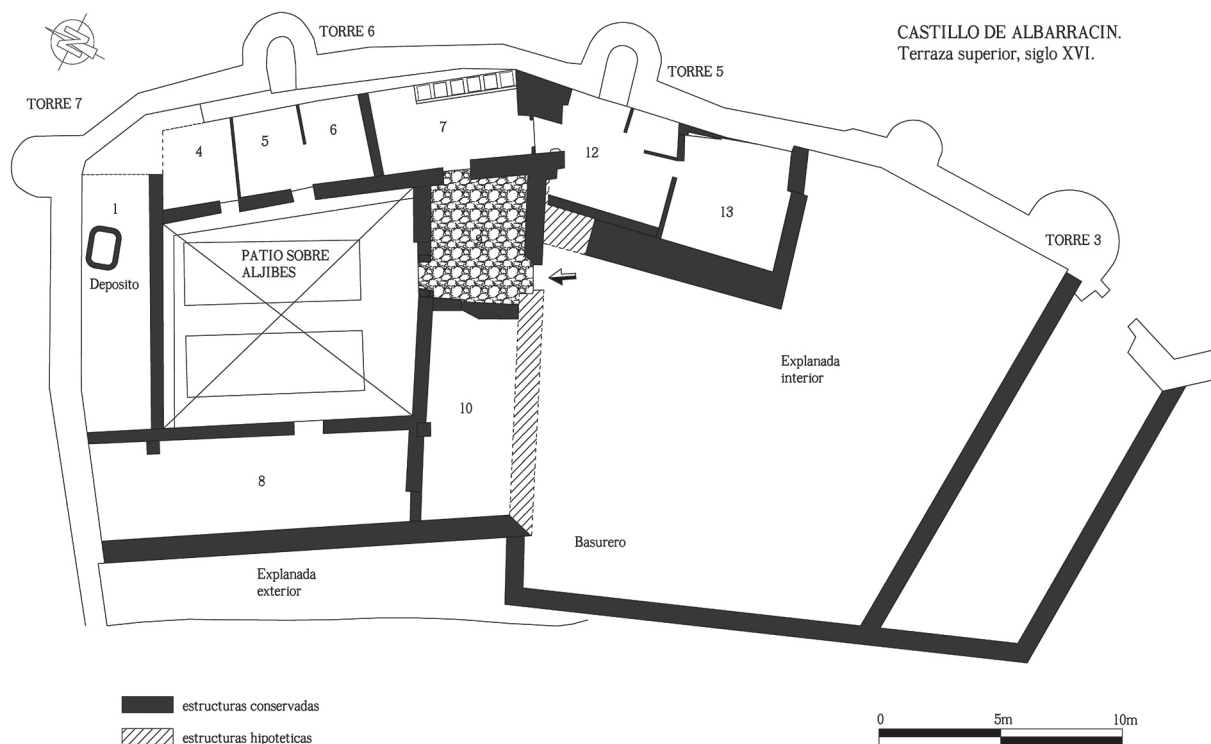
Planta con las estructuras documentadas en la zona alta, período 3.
